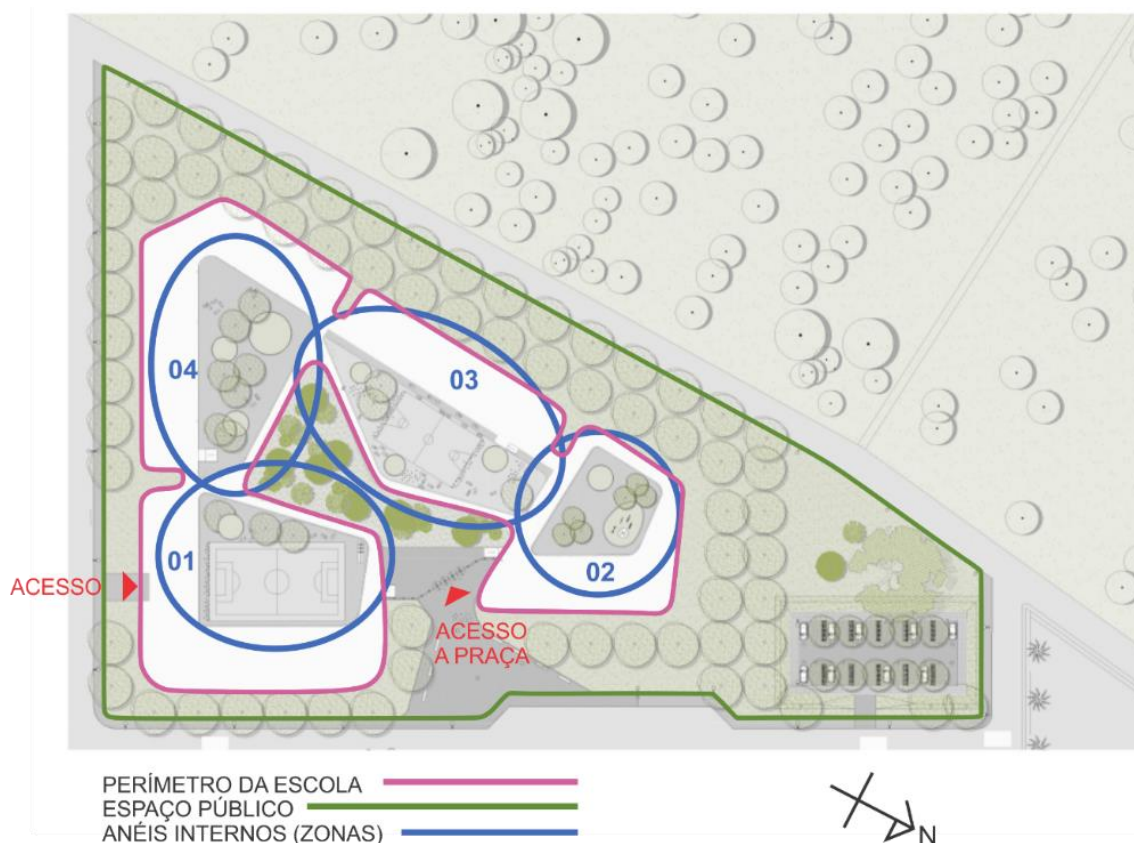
Planta baixa de implantação, Escola Flor do Campo
